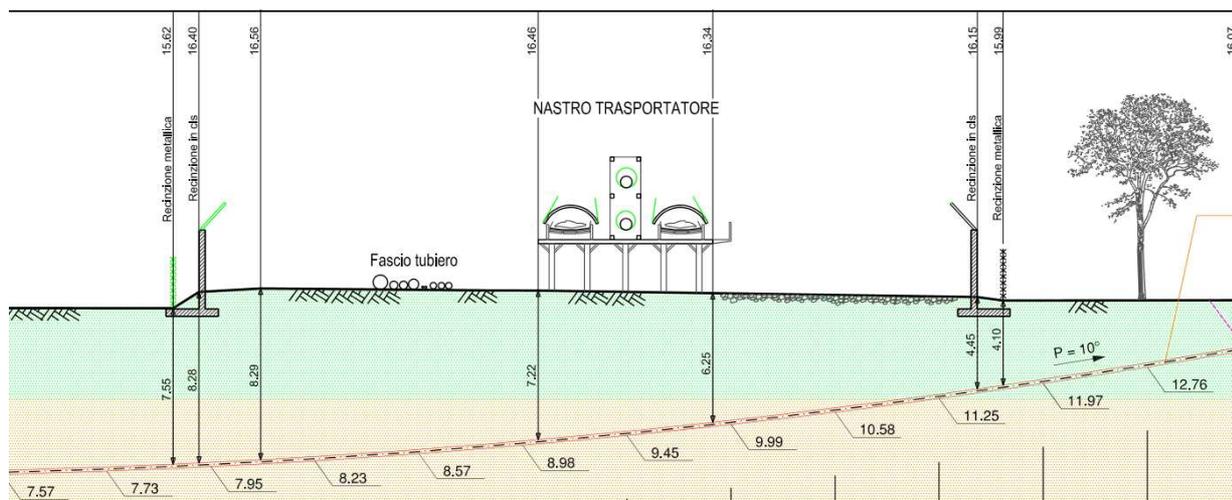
profilo della TOC n. 4 sotto il fascio tubiero
